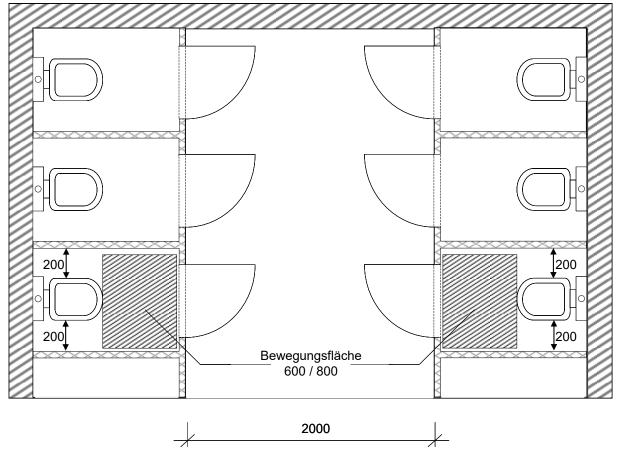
Zweibündige Toilettenanlage, Türanschlag nach außen (Maße in mm)
